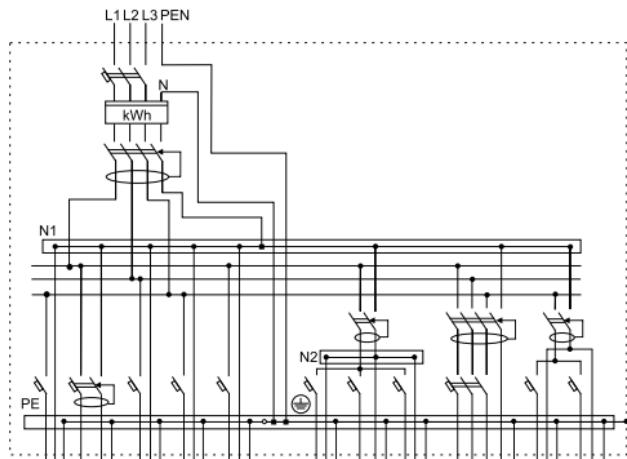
Схема квартирного учетно-группового щитка (для комтеджа)
